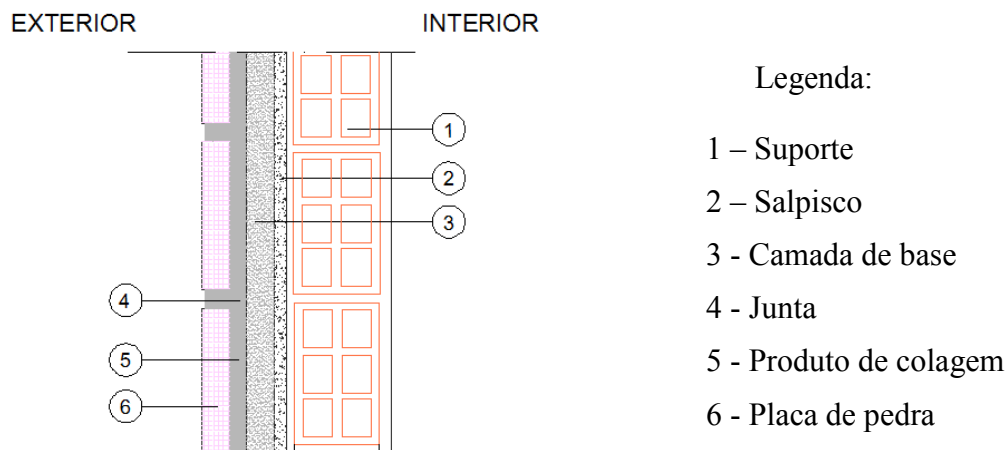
Pormenor de constituição de uma parede revestida com placas de pedra colada
